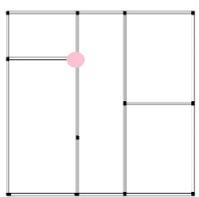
Visão Geral das Estruturas – Pilares, Vigas e Laje Treliçada.
